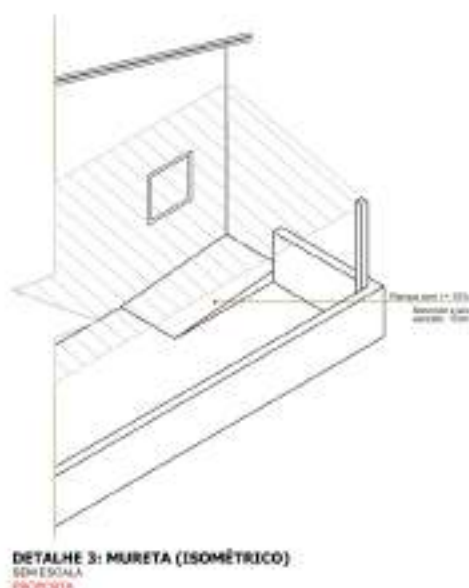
Local onde será construída a mureta, esta deve seguir o contorno da estrutura de madeira (pilares) do telhado.
